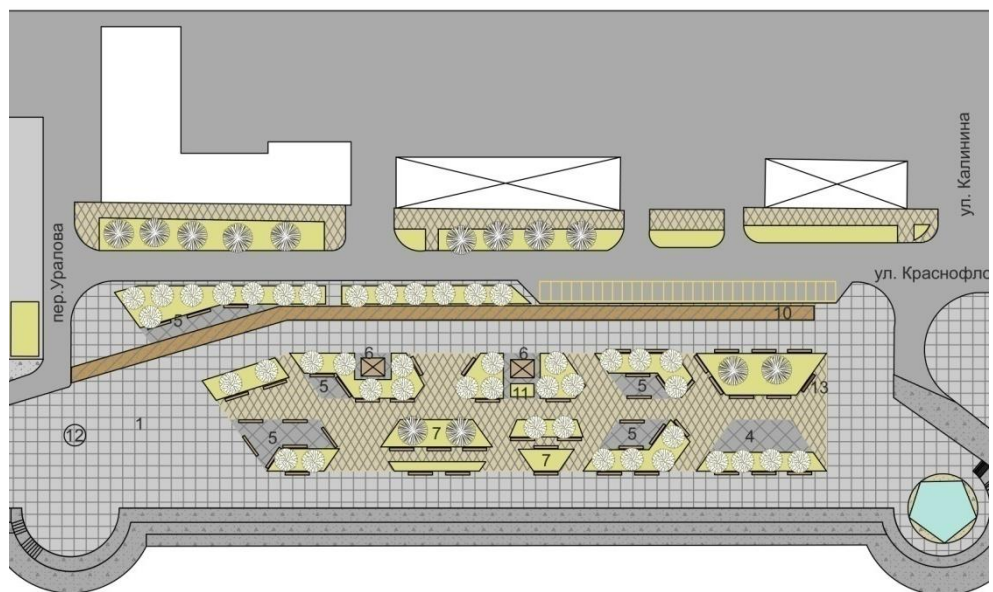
Фрагмент генплана набережной р. Амур. Зона земли
